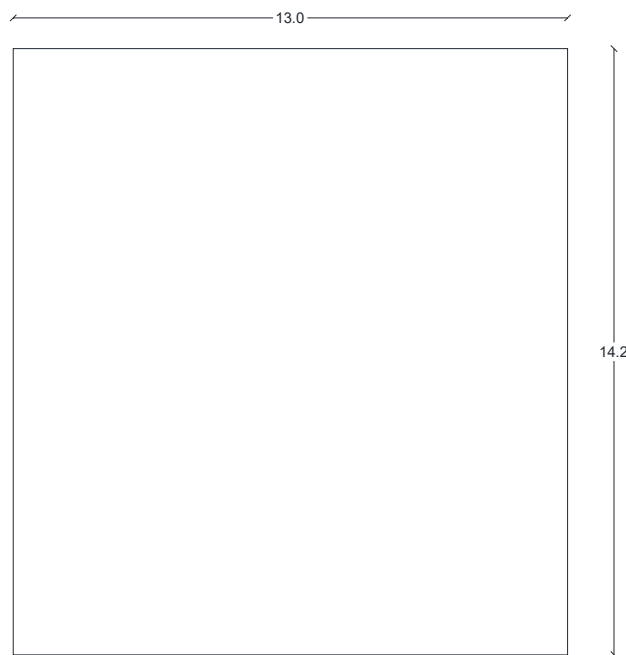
PLANTA CON DIMENSIONES TOTALES
